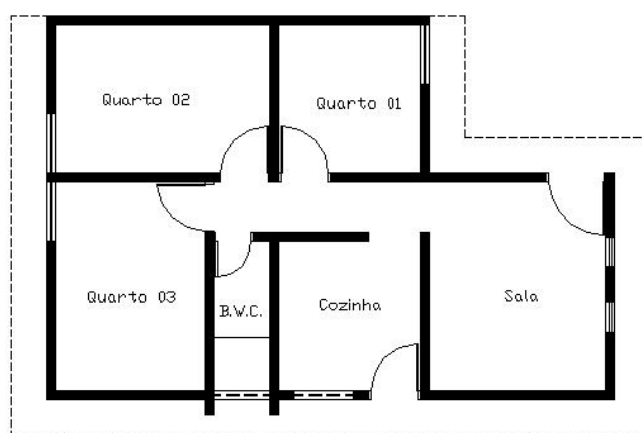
Planta baixa original das unidades habitacionais estudadas
